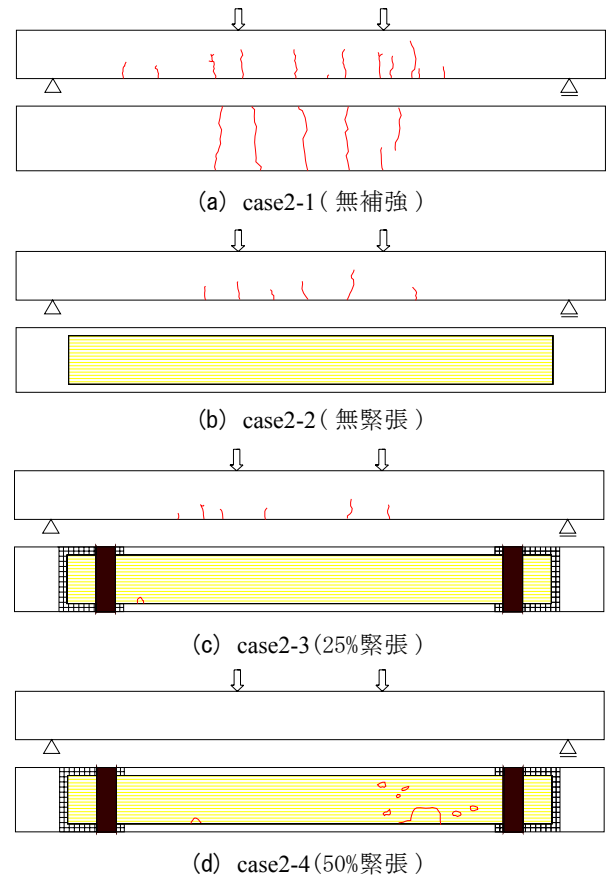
ひび割れおよびアラミド繊維シート剥離状況
